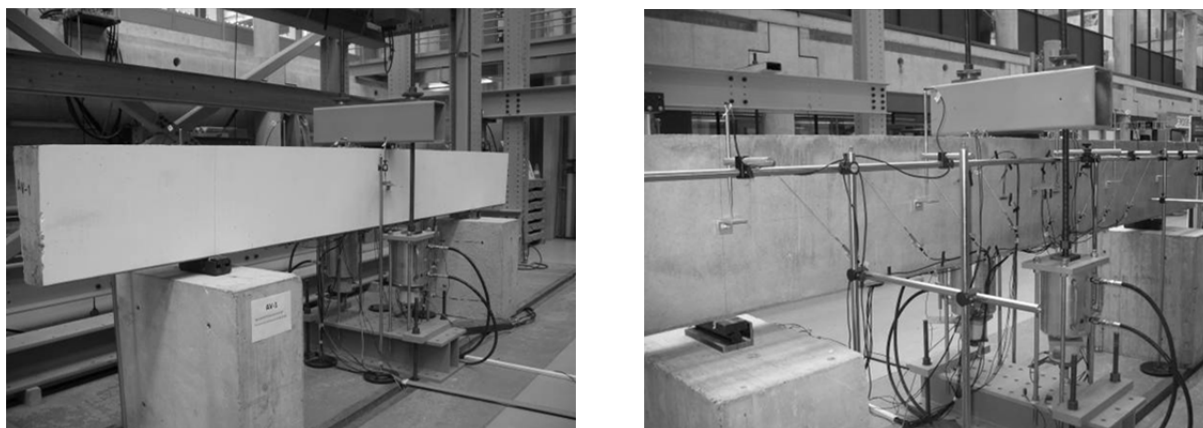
Vues du dispositif d'essai et de mesures des poutres AV.
